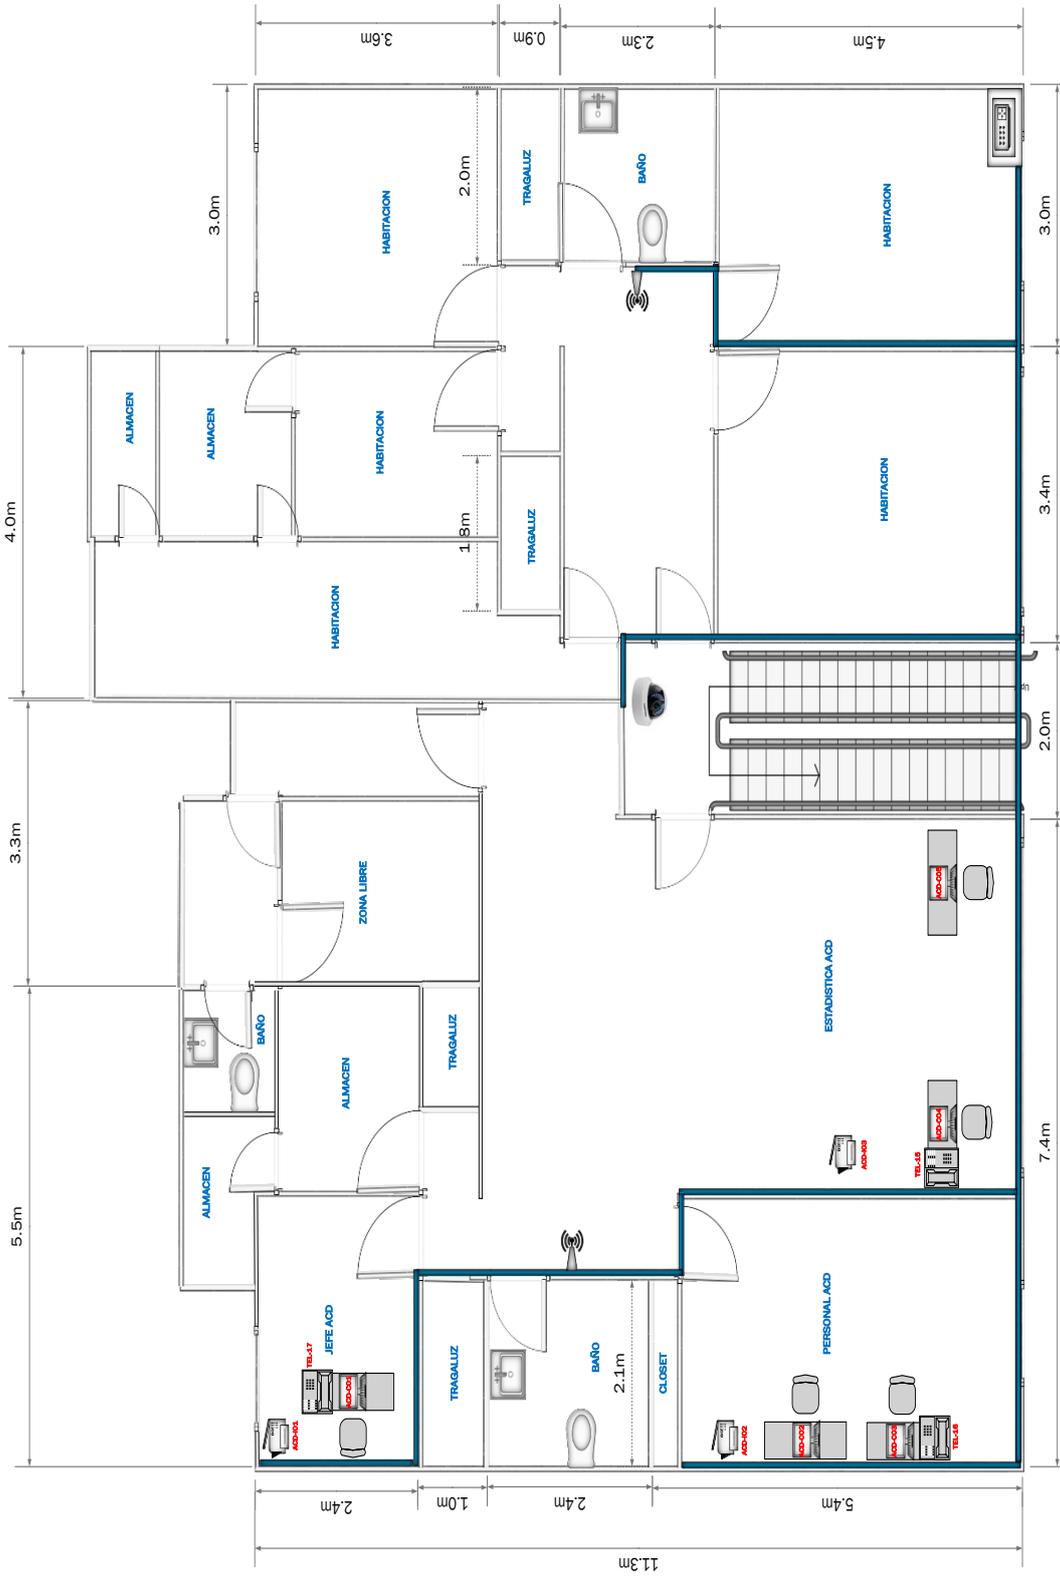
Plano del Edificio N°2-Piso N°1 con recorrido de canaletas
